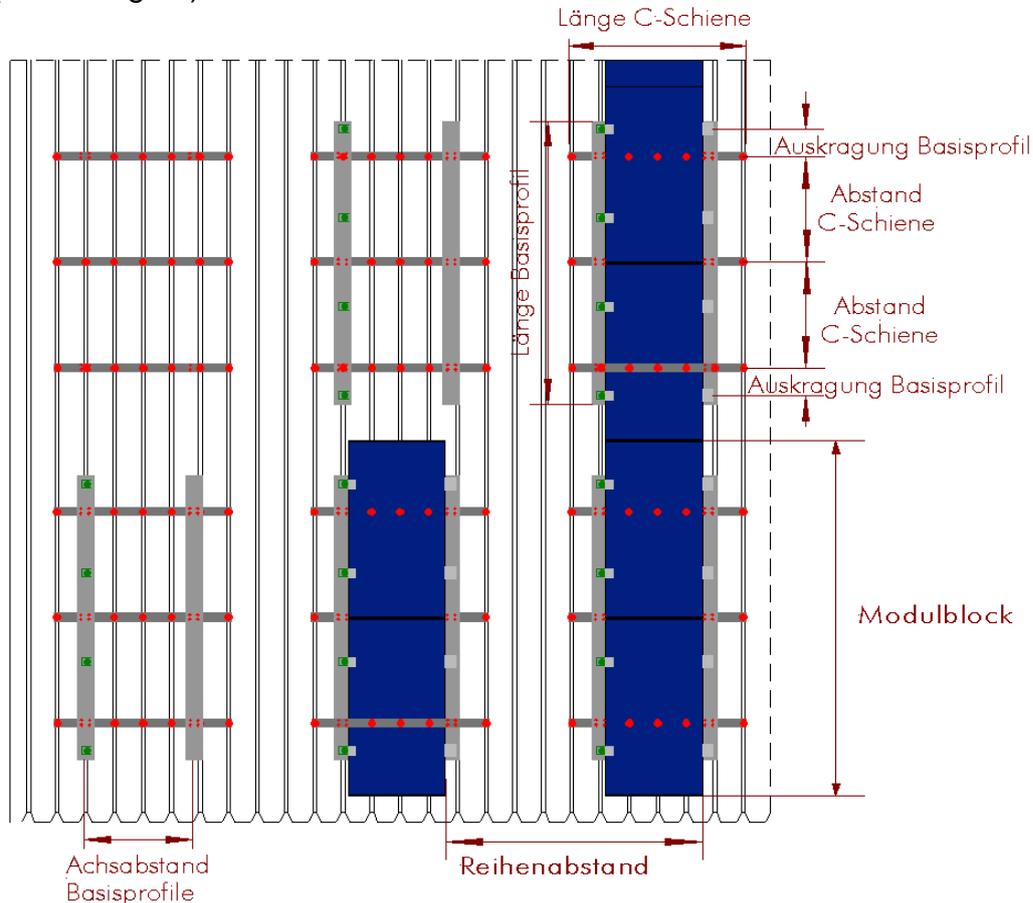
Prinzipskizze zur Befestigung des KSV am Trapezblechdach
